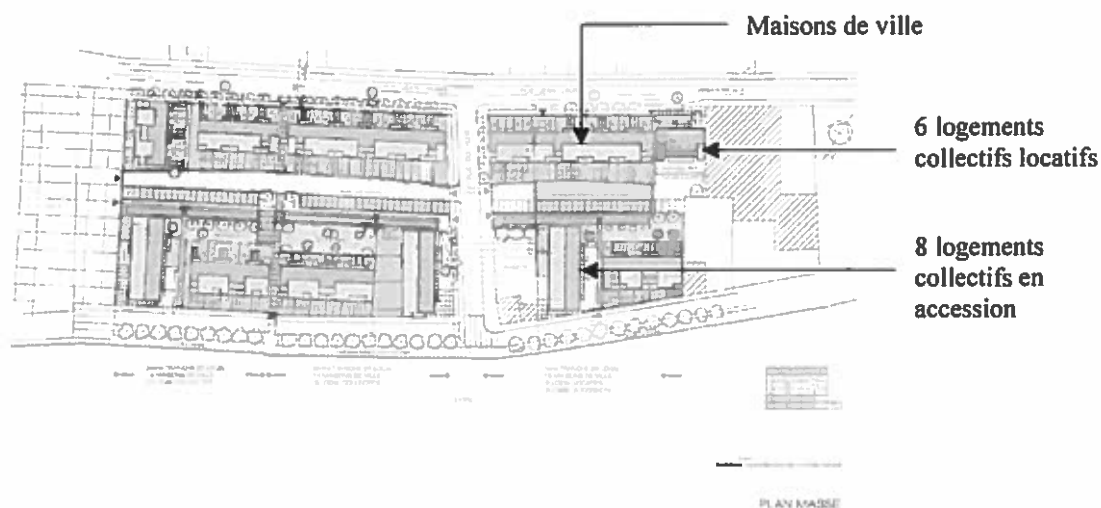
Plan masse des îlots de l'opération, la première tranche se situe à droite.
